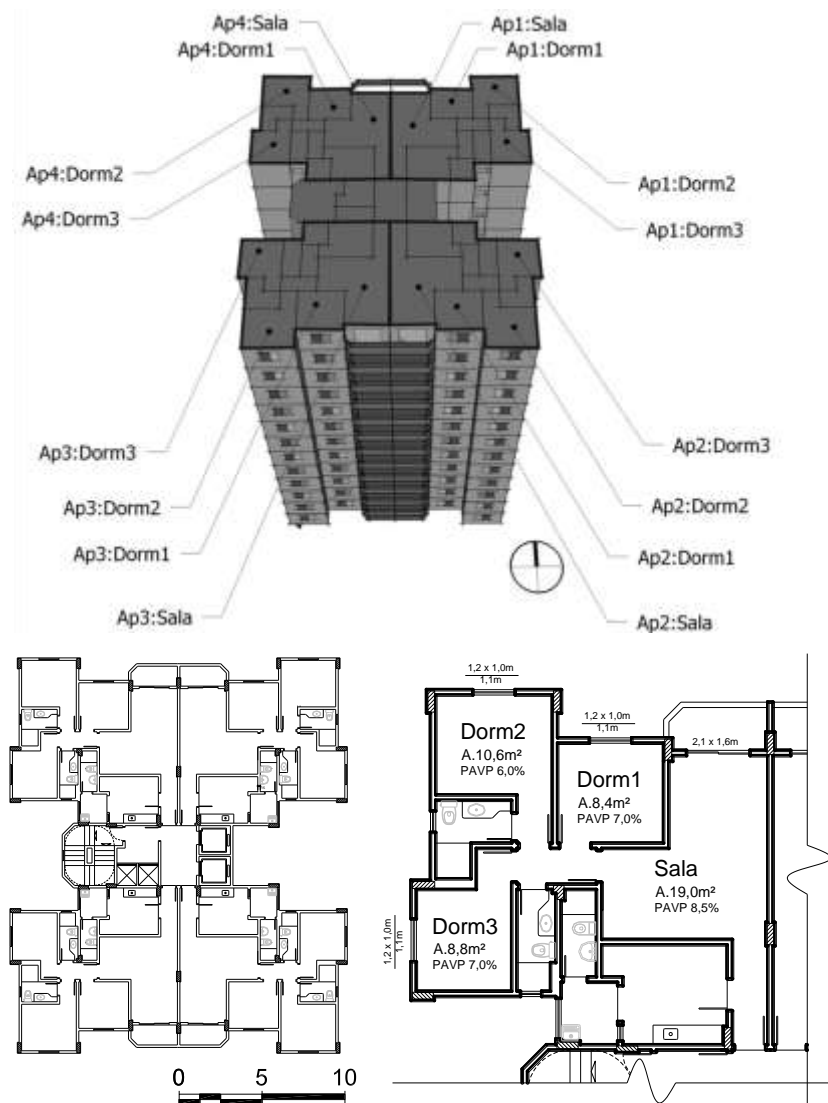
Esquema e plantas do pavimento tipo e apartamento do Modelo real
